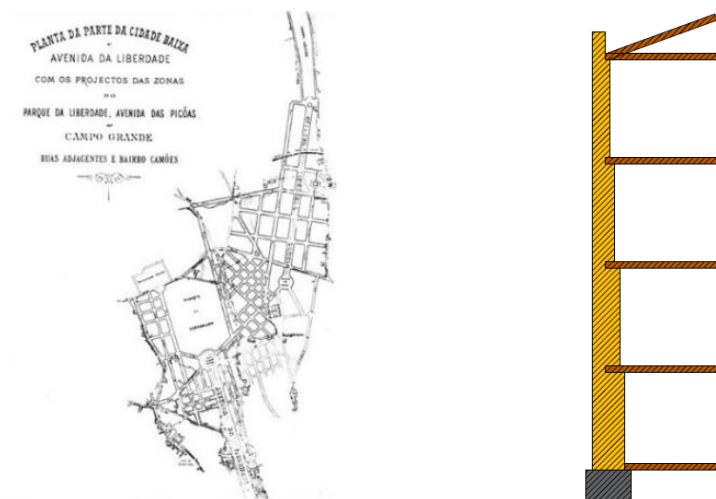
Representação esquemática de uma planta das Avenidas Novas [31] e de parede exterior dos edifícios Gaioleiros [5]
